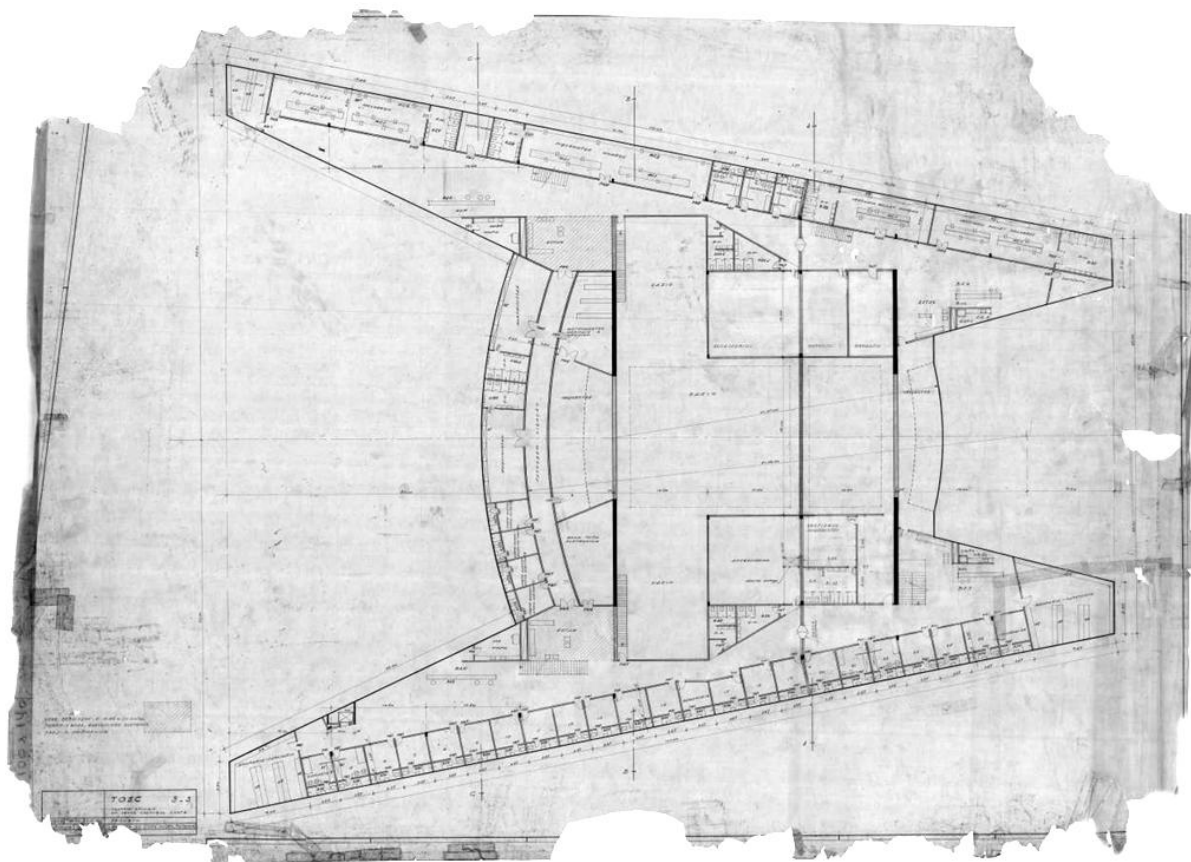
Planta Baixa - Subsolo 4 (1960). Carimbo: Teatros Oficiais no Setor Cultural Norte, TOSC, 5.3. Conteúdo: Planta da cota -13,80. Data: 03/03/1960. Fonte: ARPDF.
